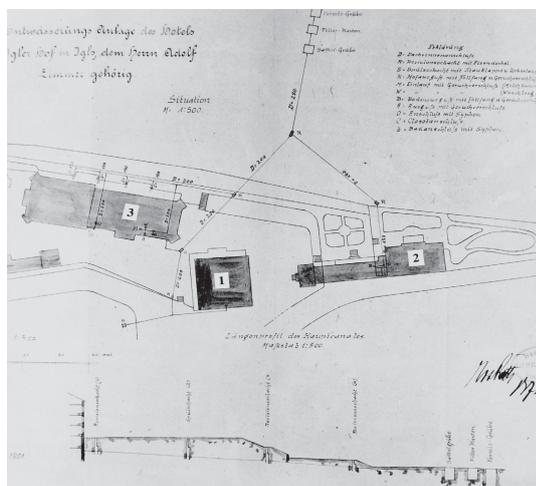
Grundriss Hotelanlage Iglers Hof (1 Villa Waldrast, 2 Villa Fürstenhof, 3 Iglers Hof). Plan 33,5 x 41,0 cm, „Entwässerungs-Anlage des Hotels Iglers Hof in Igls, dem Herrn Adolf Zimmer gehörig. Innsbruck, im Juni 1901. Baumeister Josef Retter Innsbruck–Wilten“. TLA, BH Innsbruck, Rep. 1901, Nr. 26483, Bau 84.
